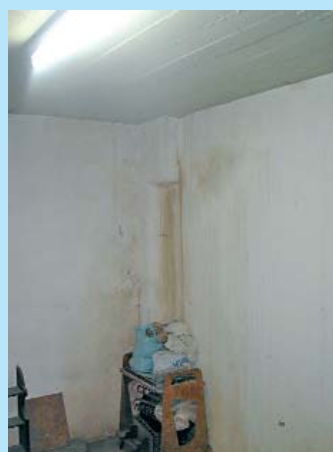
Infiltração de humidade. Deficiente isolamento dos elementos construtivos, nas caves, em relação ao terreno.
